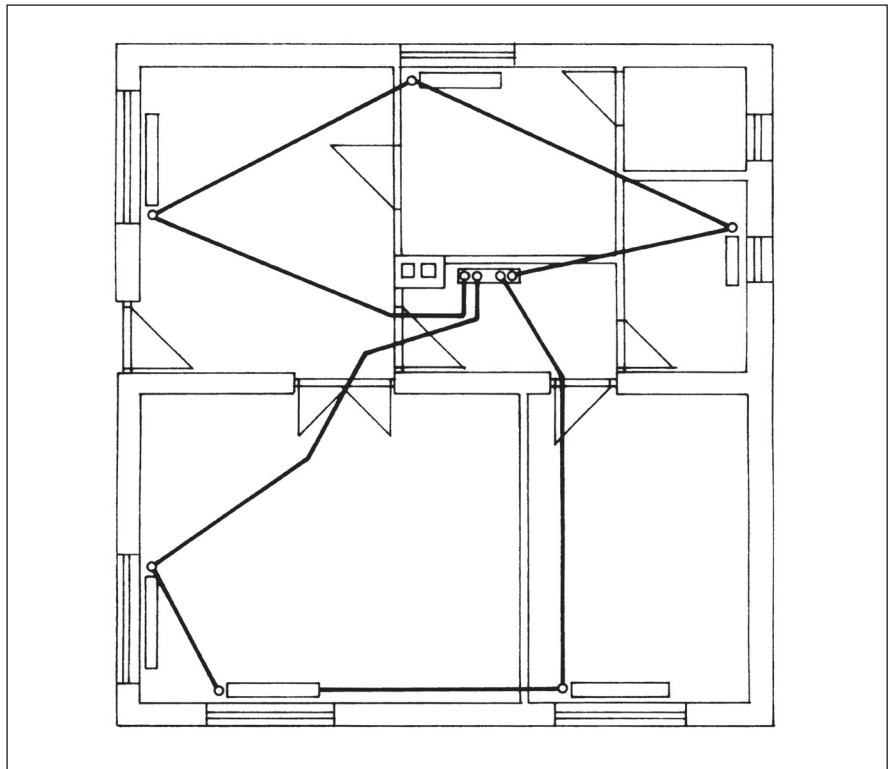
Instalace ústředního vytápění při použití různých materiálů
